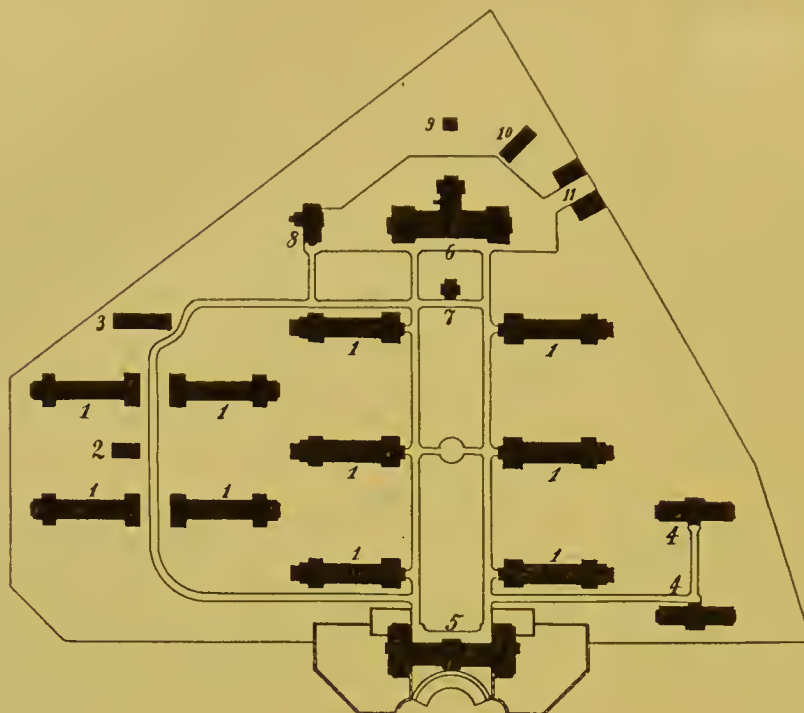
Lageplan des Krankenhauses Friedrichshain.
